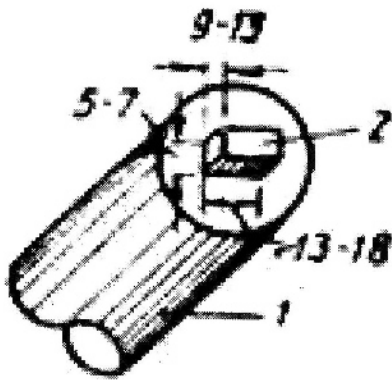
Шип для насадки нижнего венца или обвязки: 1 – ступ; 2 – шип.
